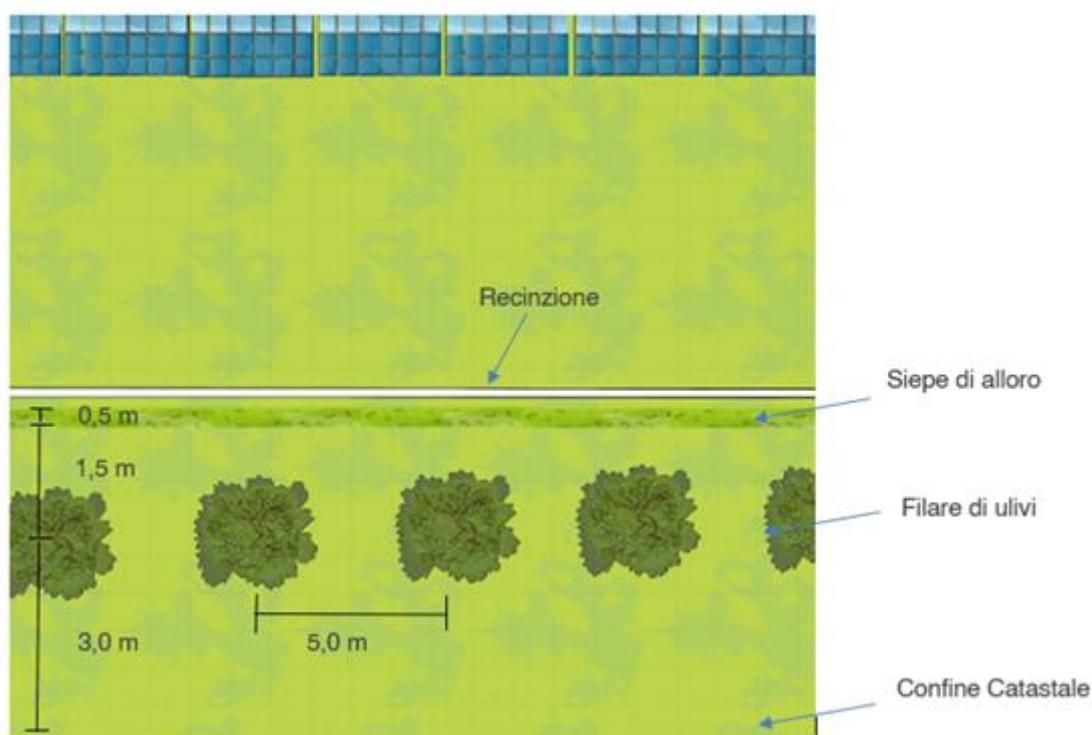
Particolare del perimetro di impianto con siepe di alloro e filare di olivi.
